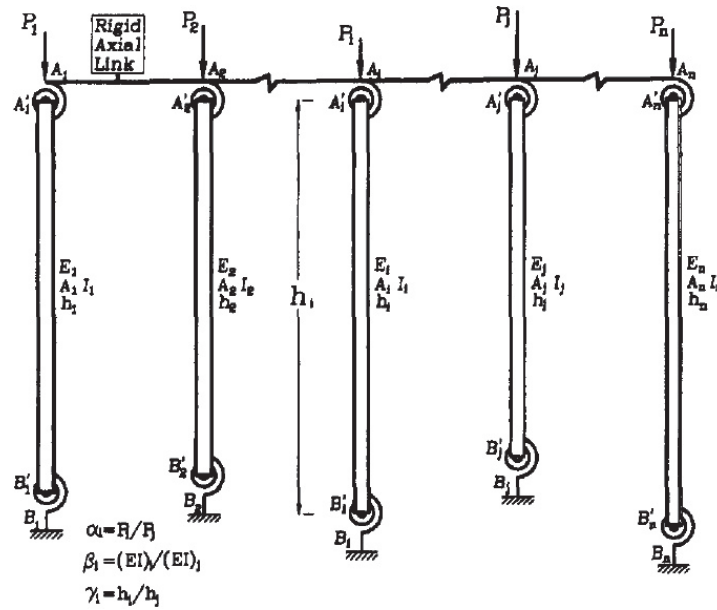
Modelo estrutural de um pórtico não contraventado [9].
